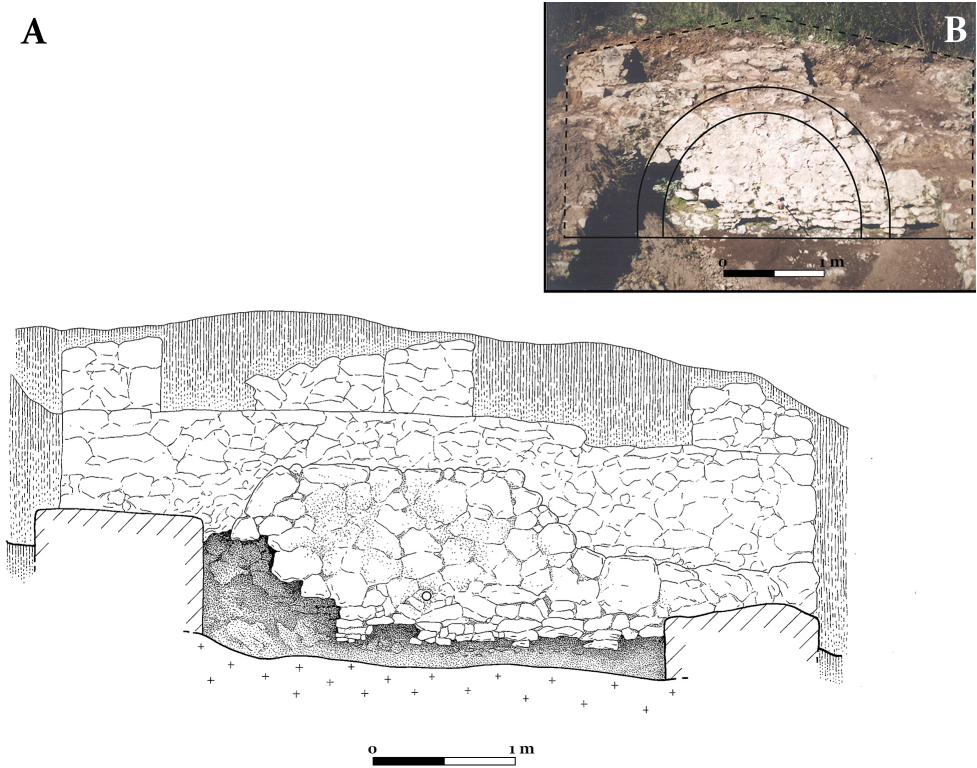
A: Alzado de la fachada de la fuente de Santa María de Reyes Godos (dibujo: Luis Pascual); B: Hipótesis reconstructiva de su alzado.
